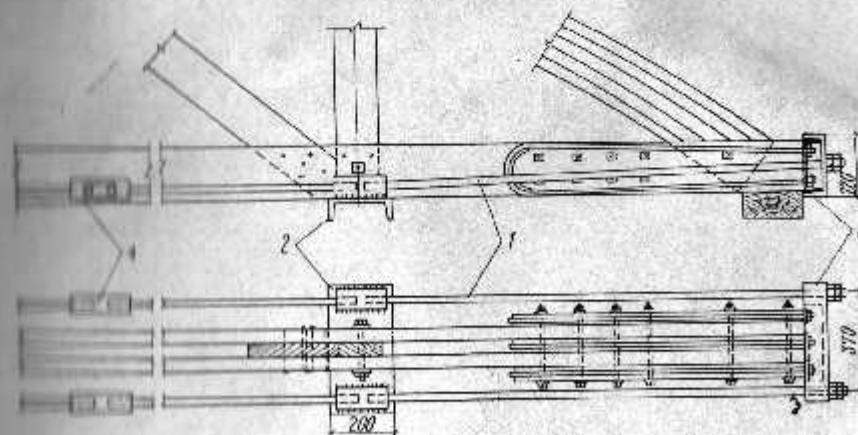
Деталь крепления тяжей в узлах нижнего пояса сегментной фермы (см. рис. 15)
